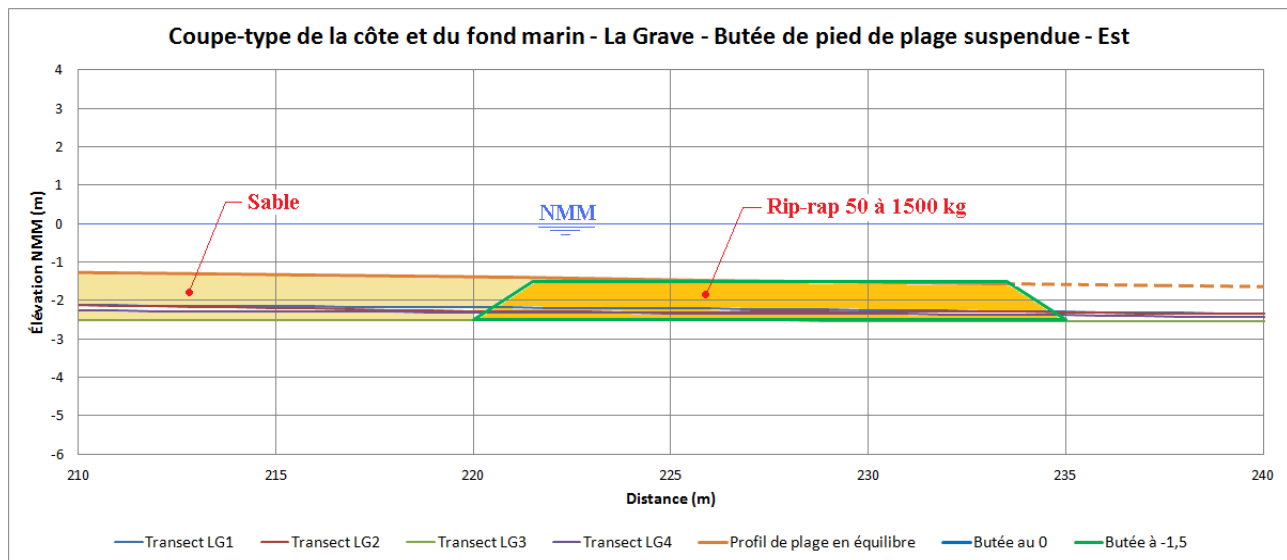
Coupe type d'une butée de pied de plage suspendue en enrochement à -1,5 m NMM
